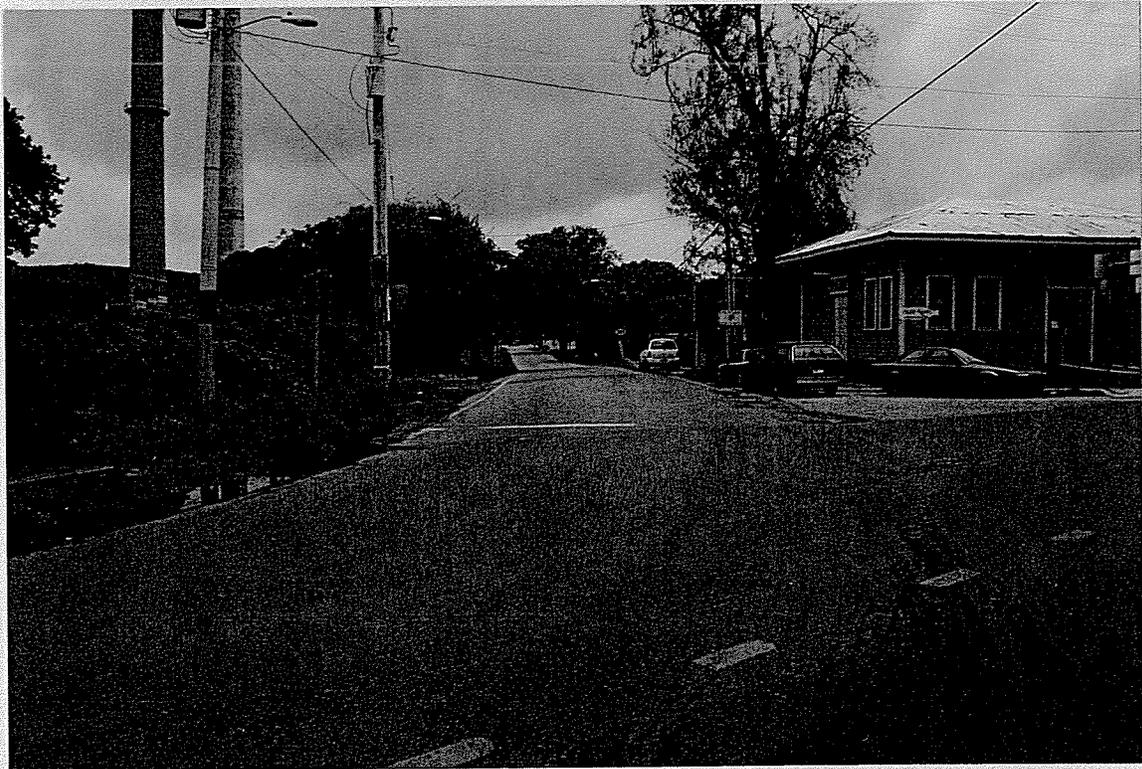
INTERSECCIÓN CARRETERAS PR-3116 Y PR-325, ACCESO ESTE
